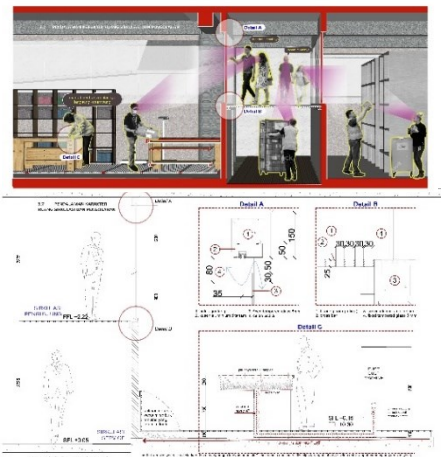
Perspektif Ruang Pengolahan Limbah
